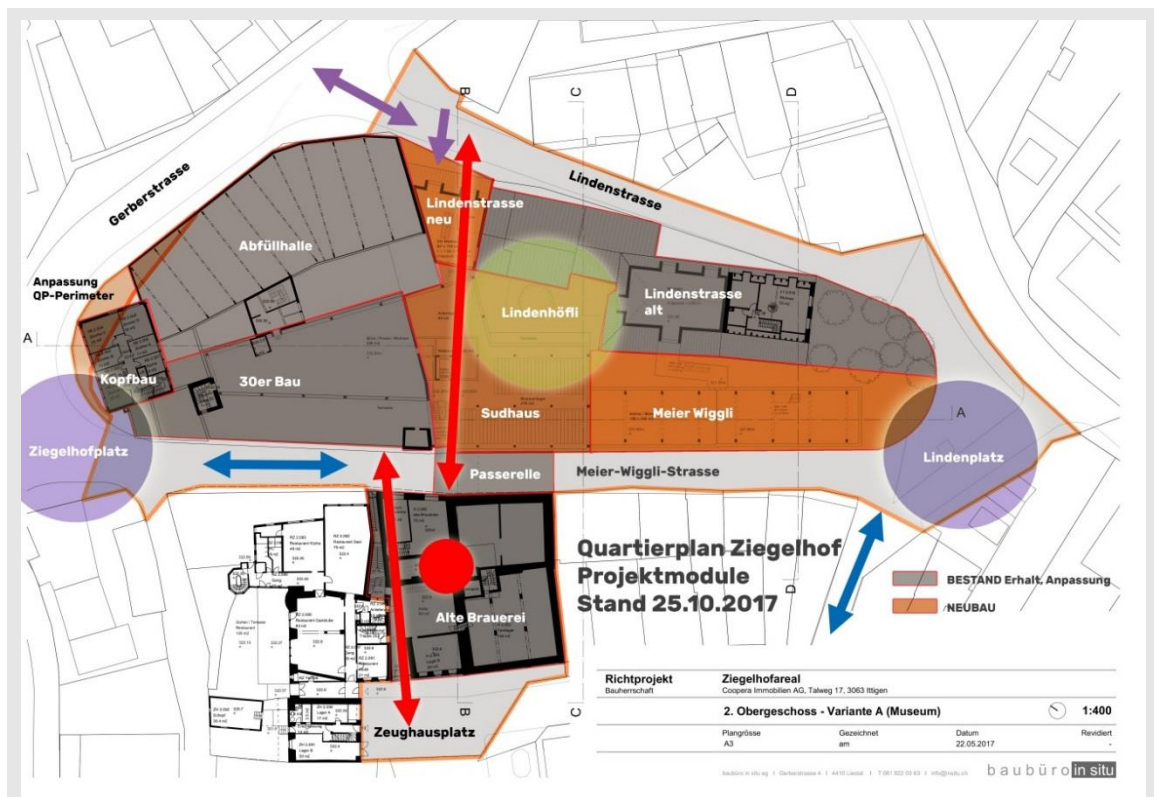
Situationsplan mit Projektmodulen und Durchwegung, Plan: Baubüro in situ AG
